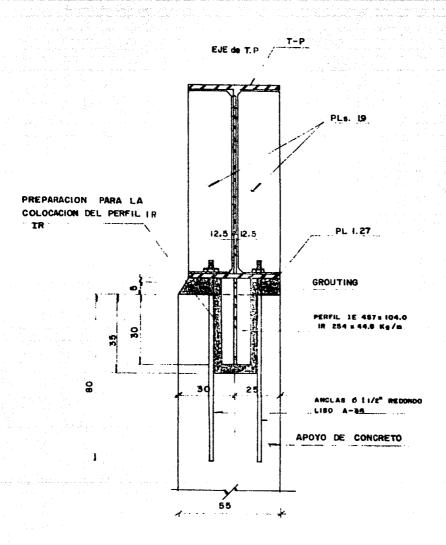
ANCLAJE DEL MURO TAPON A LA ESTRUCTURA METALICA.
